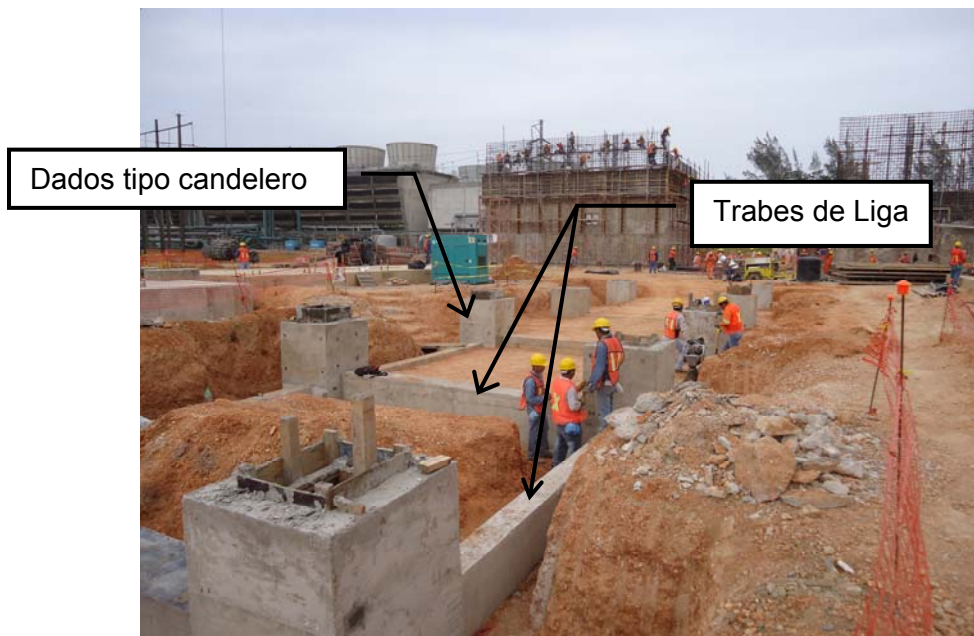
Cimentación a base de dados tipo candelero y traves de liga
